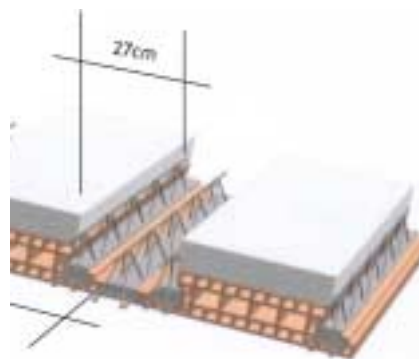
È possibile aumentare la sezione della canaletta interponendo un travetto tralicciato.
